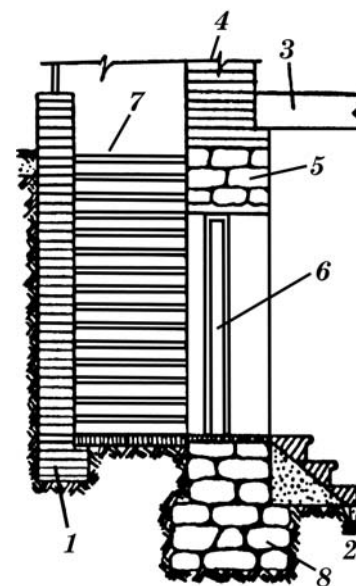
Общий вид схемы конструктивного узла приямка спуска в подвальное помещение при помощи двух маршевых лестниц, расположенных на разных уровнях: 1 – подпорная кирпичная стена приямка; 2 – лестница с уровня 0,00 (уровня земли); 3 – перекрытие первого этажа; 4 – кирпичная стена; 5 – бутовый камень цокольной части стены; 6 – дверной проем подвального помещения; 7 – вторая лестница непосредственного спуска в подвал; 8 – бутовый камень фундамента.
